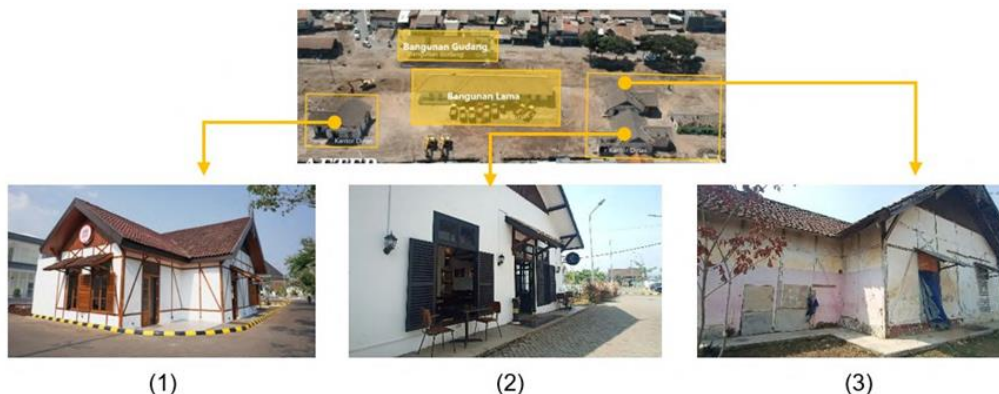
Bangunan Lama ketika Disewakan pada Ormas
